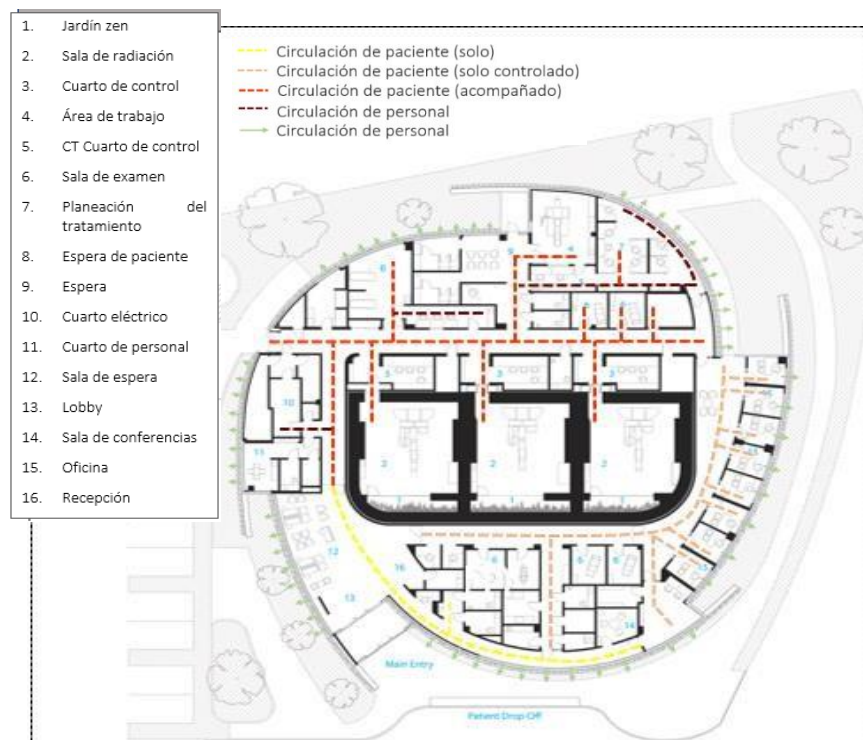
Planta Arquitectónica Centro de Oncología Radiación Kraemer. Adaptado de Archdaily
